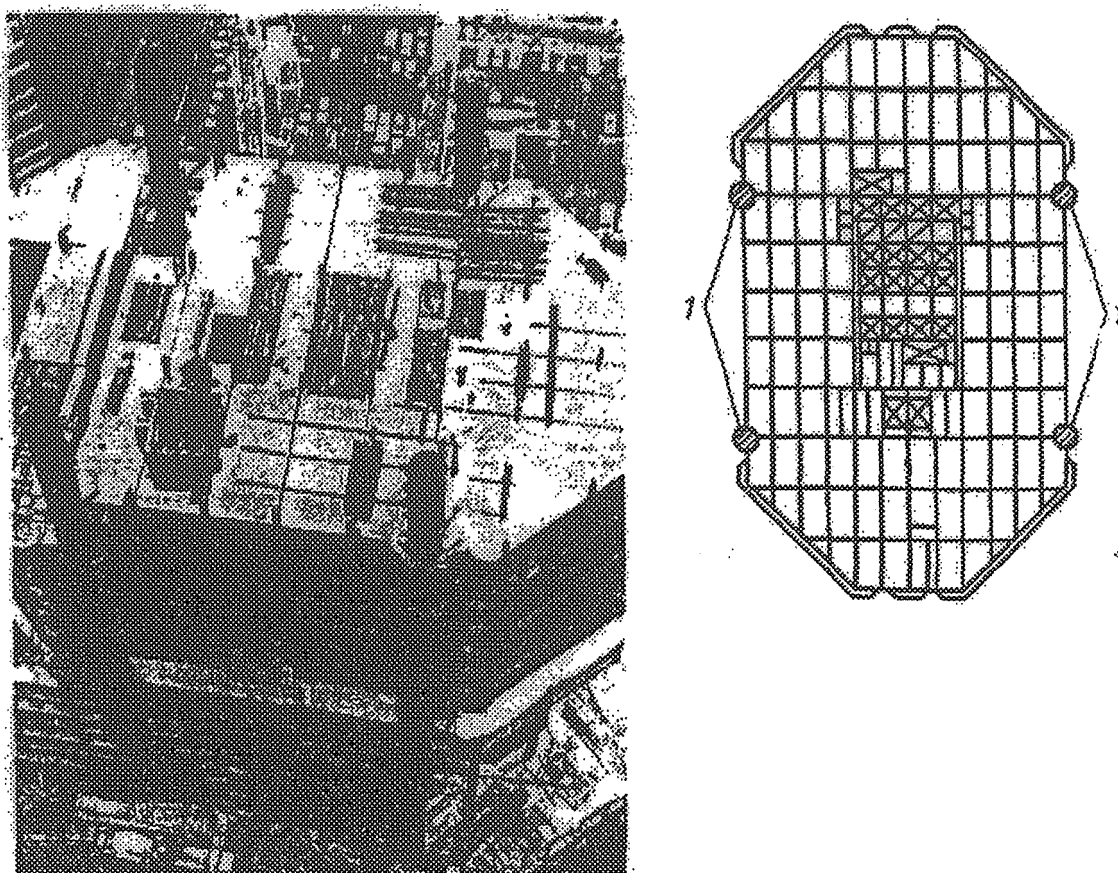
Общий вид и план типового этажа 62-этажного административного здания с трубобетонными колоннами (1)
